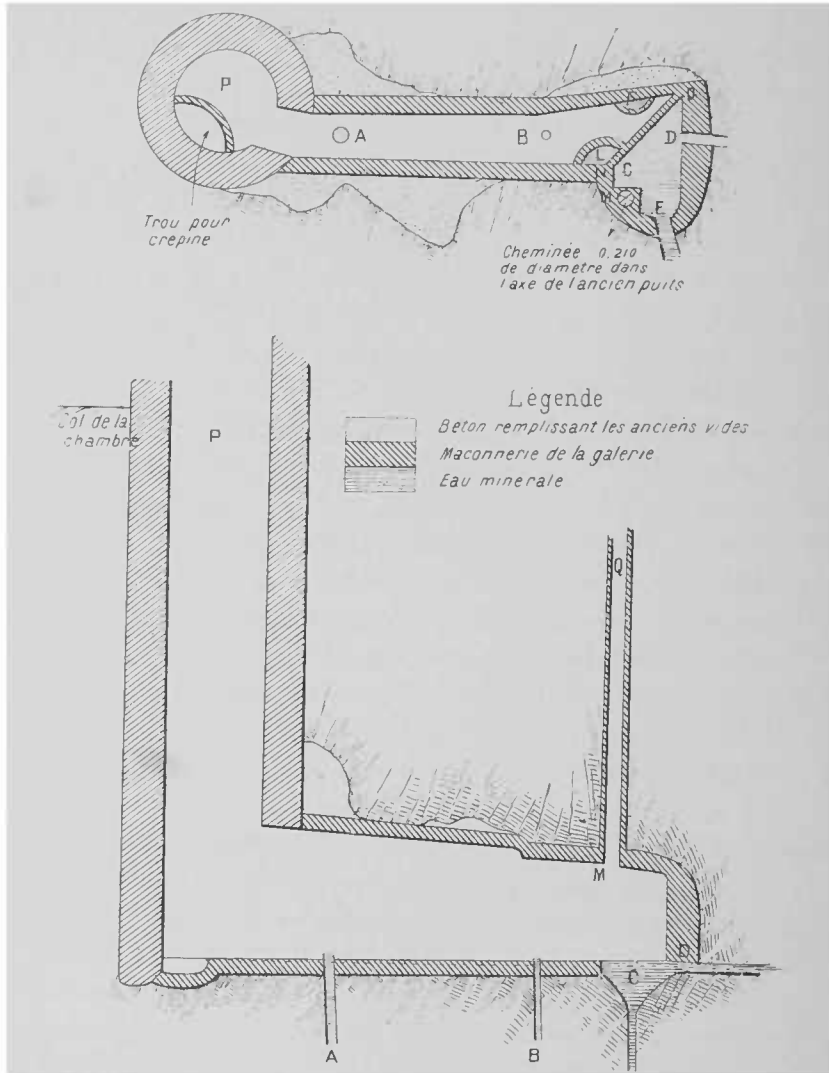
et 67. — Coupe et plan au puits Lucas de Vichy. (Travaux de 1888.)
